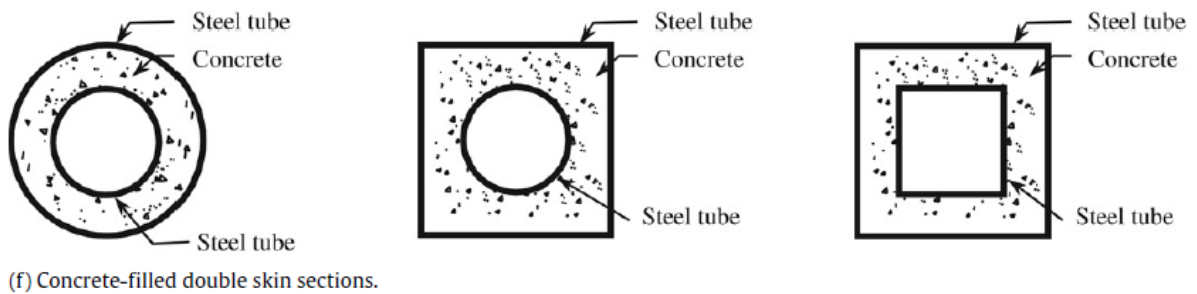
(f) Secciones con doble perfil en acero relleno de concreto. Fuente: Tomado de referencias (Yang, Lam, & Gardner, 2008).Pág. 3773.
